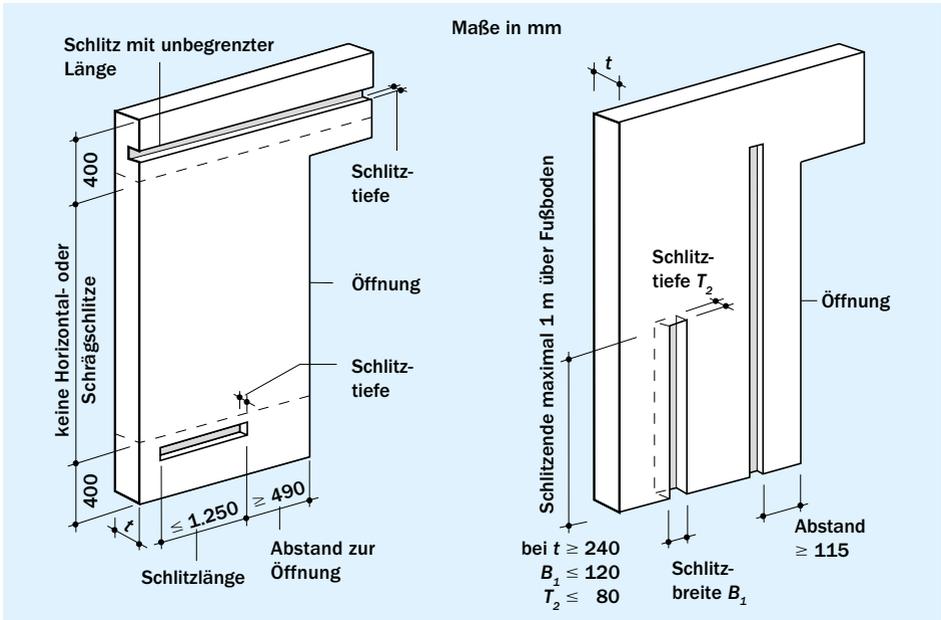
Nachträglich hergestellte horizontale und schräge Schlitzte (links); nachträglich hergestellte vertikale Schlitzte und Aussparungen (rechts)
